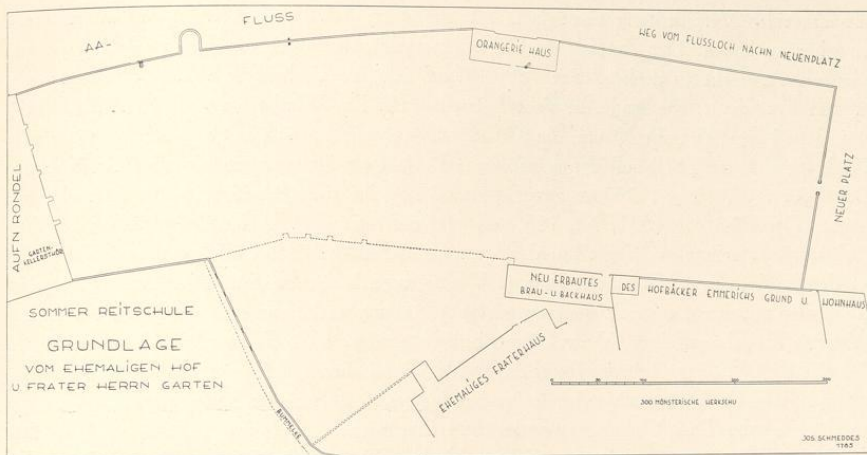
Plan des Hofgartens hinter dem Fraterhause, 1785
